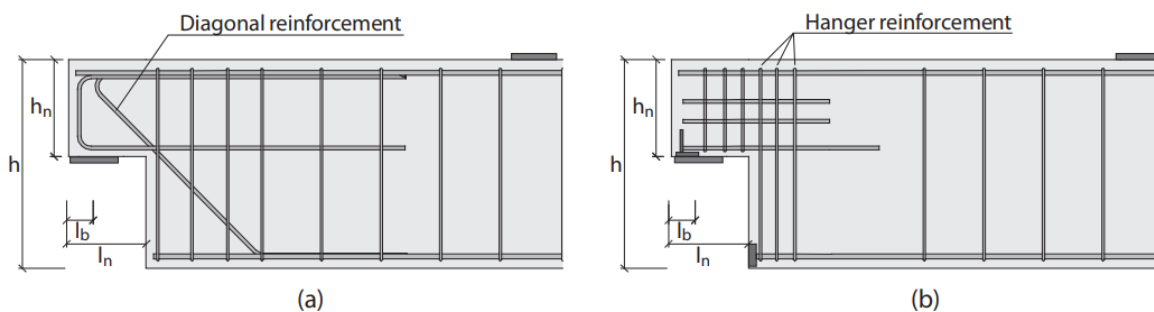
Approches de conception de poutre Gerber avec des dispositions de renforcement différentes [35]
